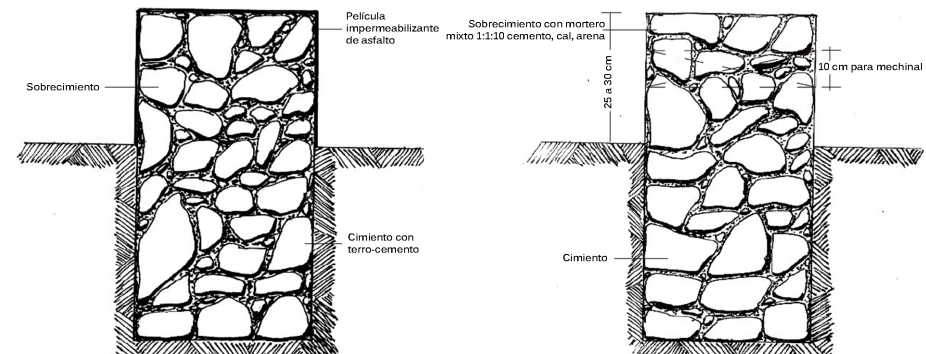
Impermeabilización de un sobrecimiento con mortero asfáltico
